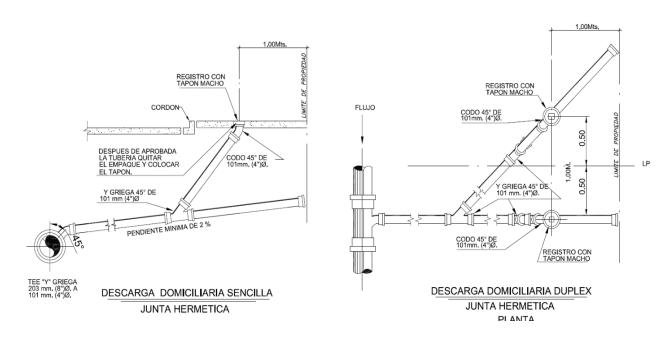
Muestra del lado izquierdo vista lateral de la colocación de descargas y del lado derecho vista superior de las descargas.
